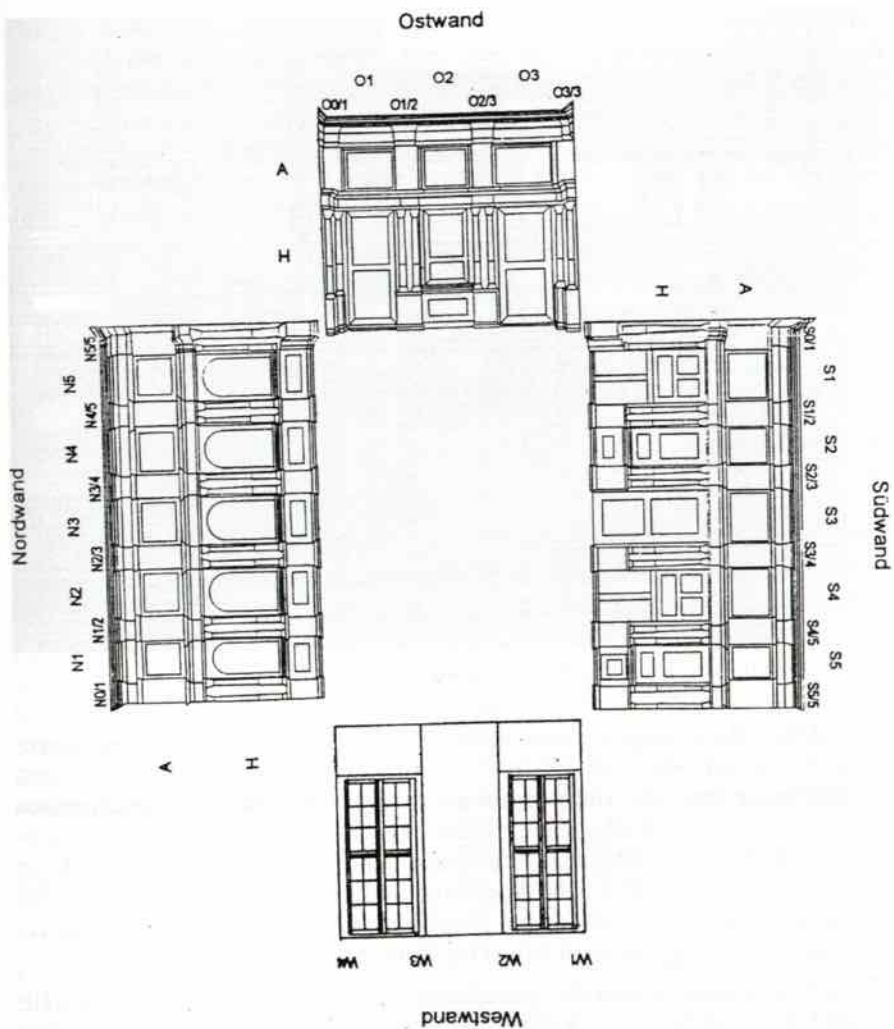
Aufrissplan der Vertäfelung mit Nomenklatur
